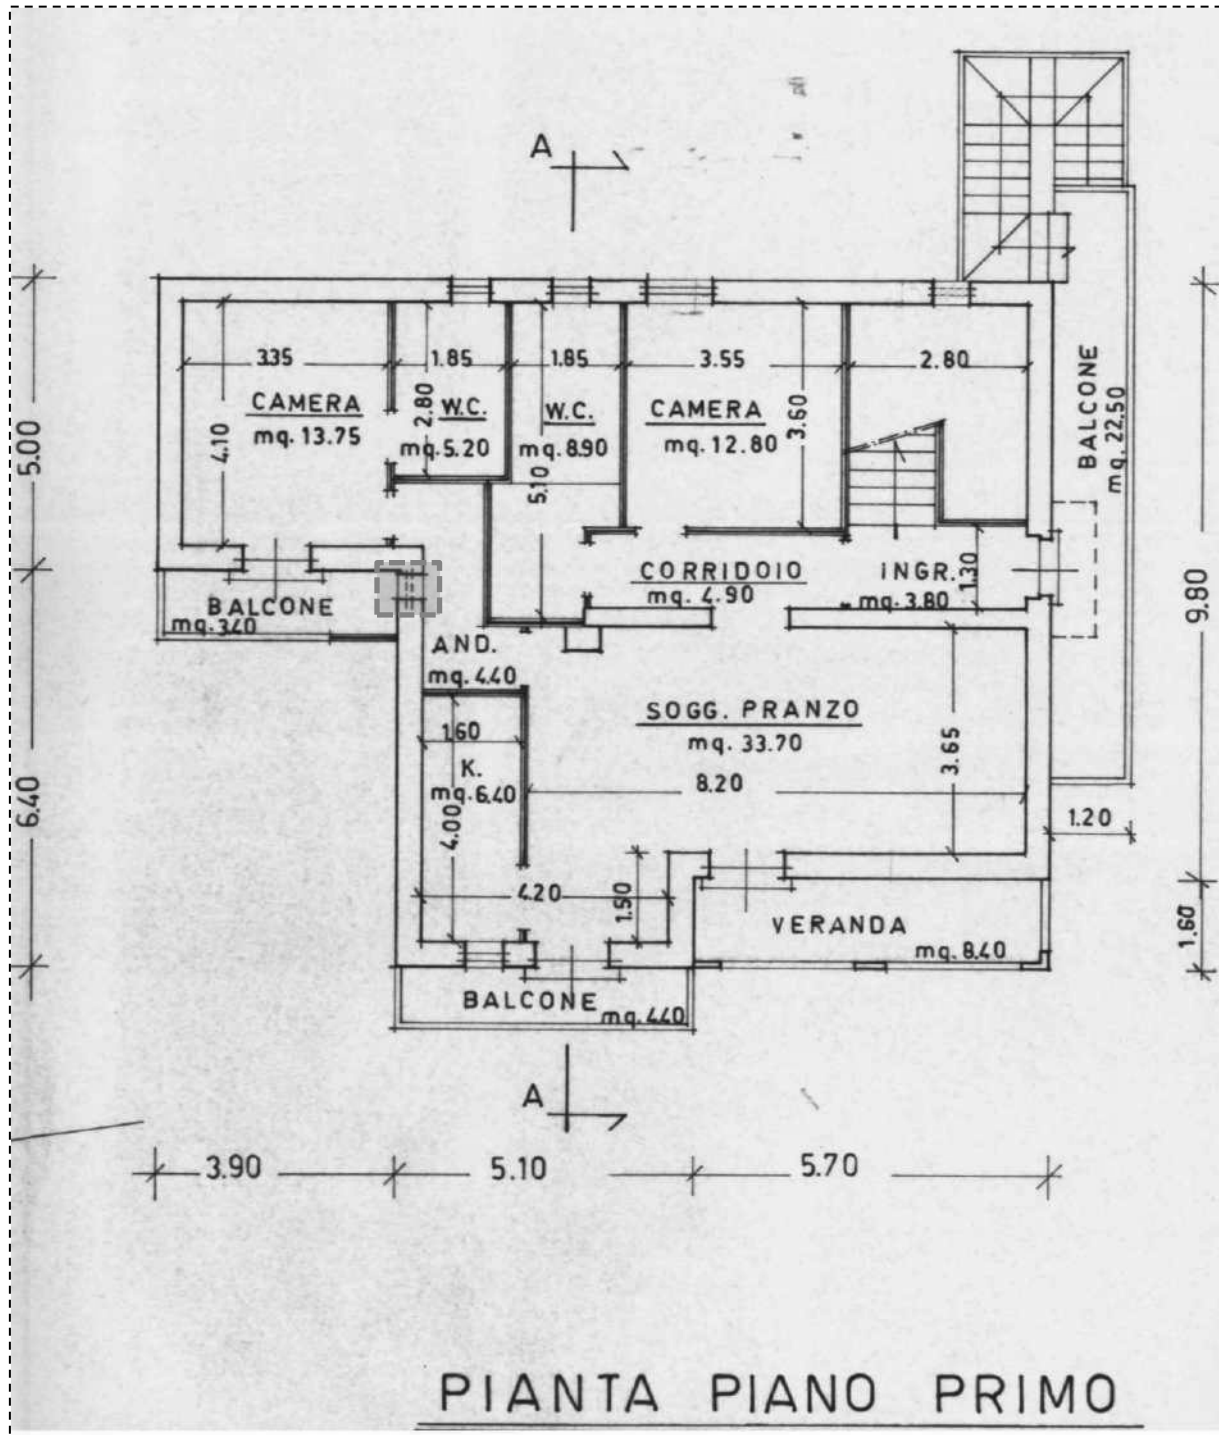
Pianta Piano Primo – Planimetria dello stato di progetto con evidenziati gli elementi realizzati in diffinità
